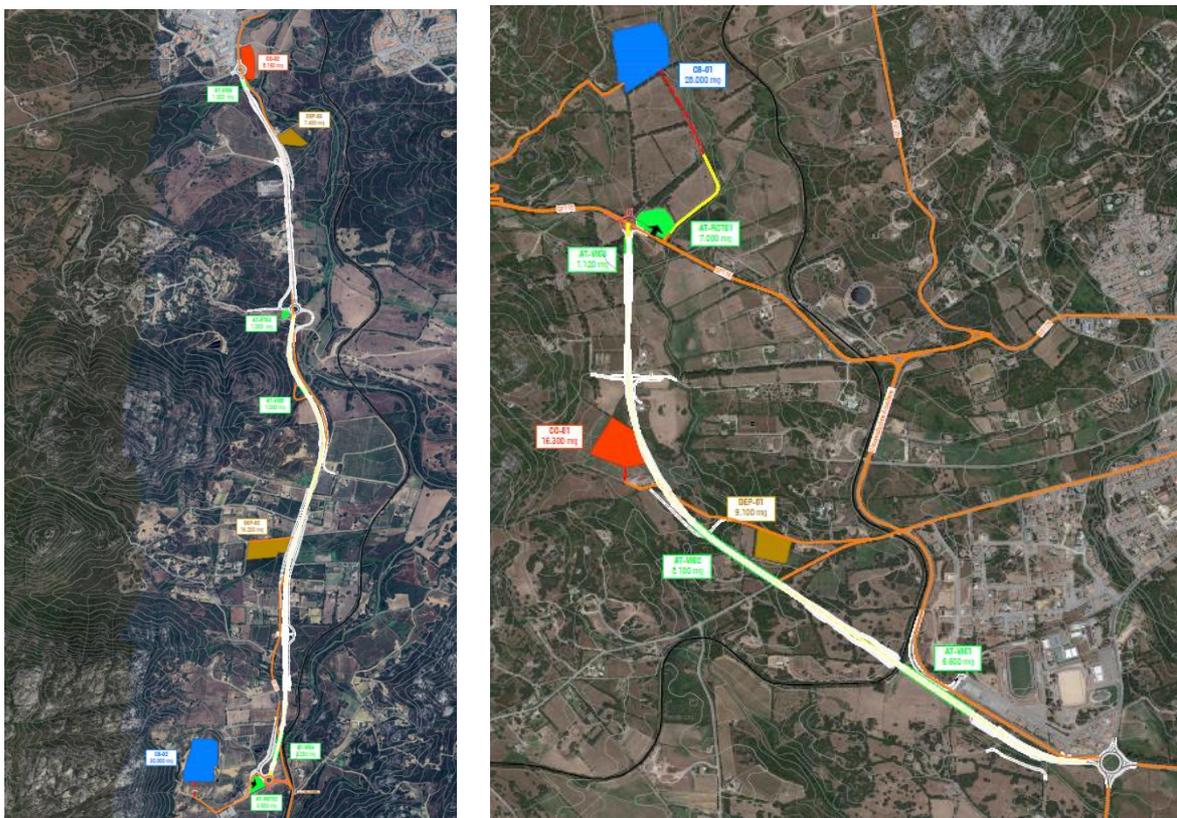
Localizzazione delle aree di cantiere rispetto il tracciato di progetto
